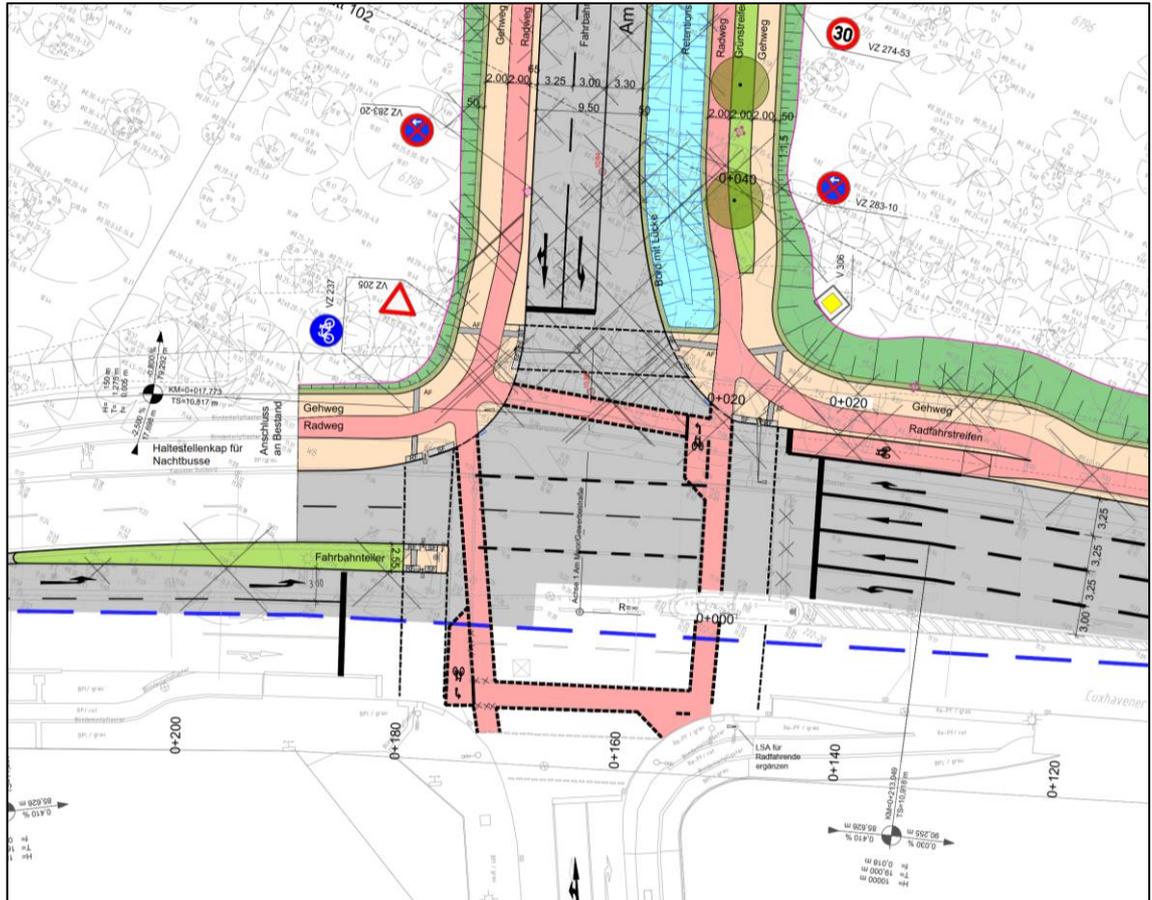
Lageplankonzept Cuxhavener Straße / Im Fischbeker Heidbrook (Ost)
